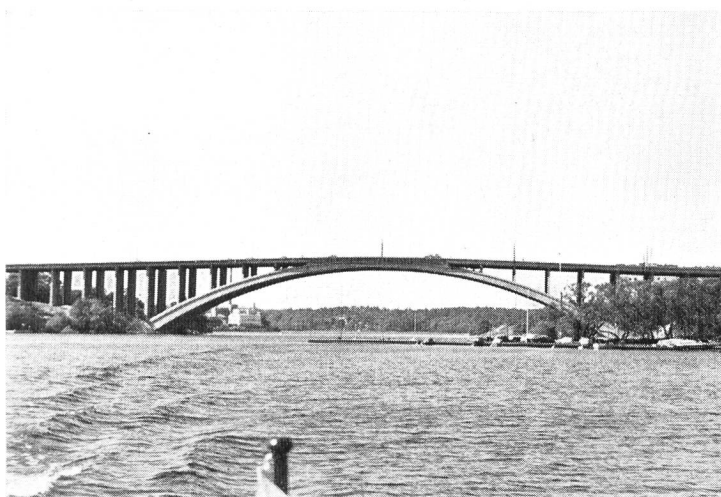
Große Eisenbeton-Bogenbrücke über dem Mälarsee in Stockholm
